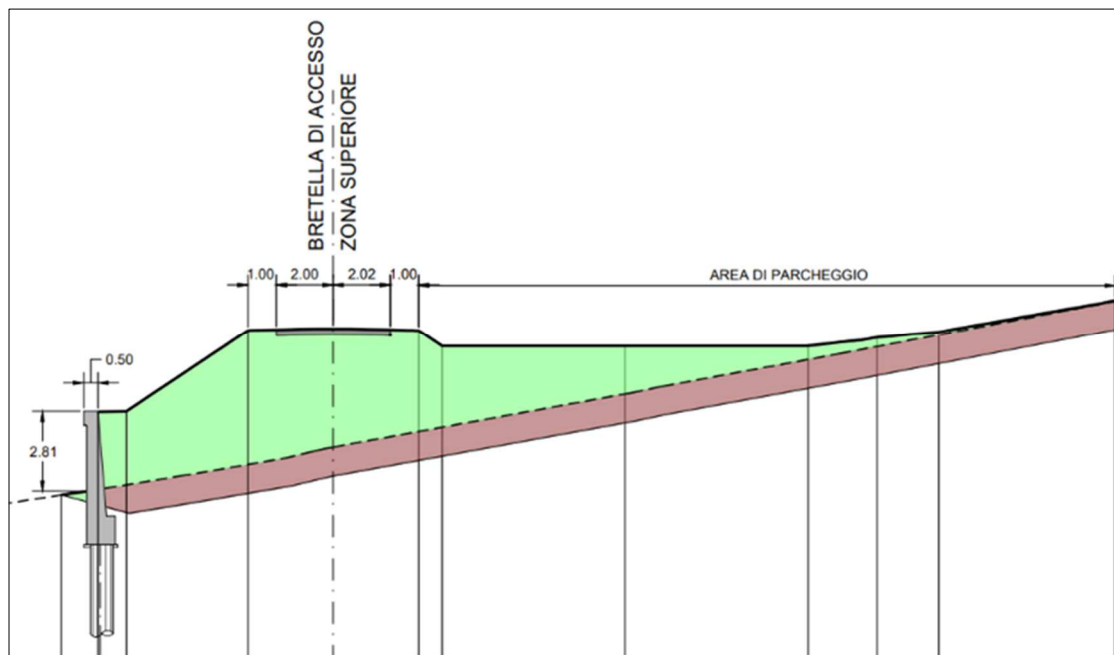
Sezione trasversale della rampa di accesso al piazzale di produzione rappresentativa delle opere di sostegno. Sezione 3-3 da elaborato di progetto (GRE.EEC.D.28.IT.13407.00.061.00)
